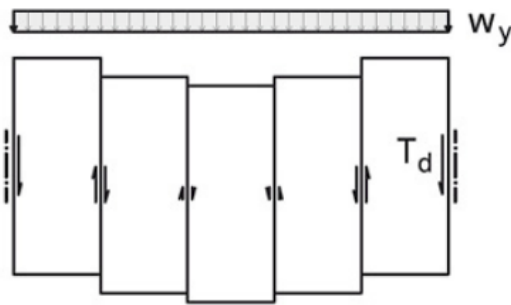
Detalles de Elemento Colector utilizado en diafragmas de CLT. Elaboración propia
